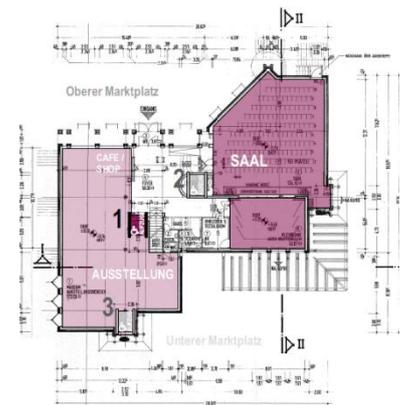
Grundriss des Erdgeschosses des Bürgerhauses. AC Planergruppe
